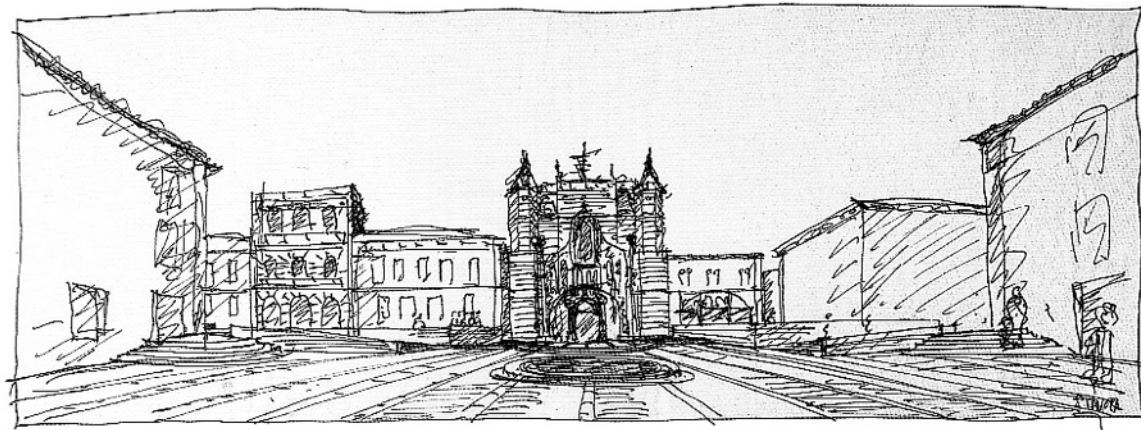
Esquisso da proposta para a praça 8 de Maio.
